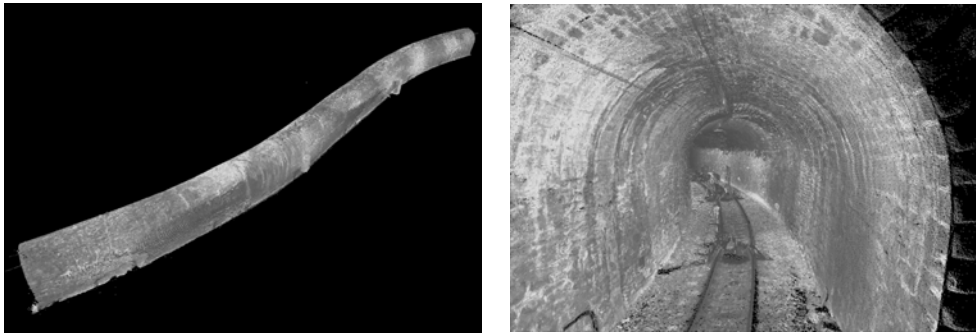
+ 6b: 3D-Laserscanner-Punktwolken des Tunnels (links: Tunnelröhre; rechts: Tunnelausschnitt)
